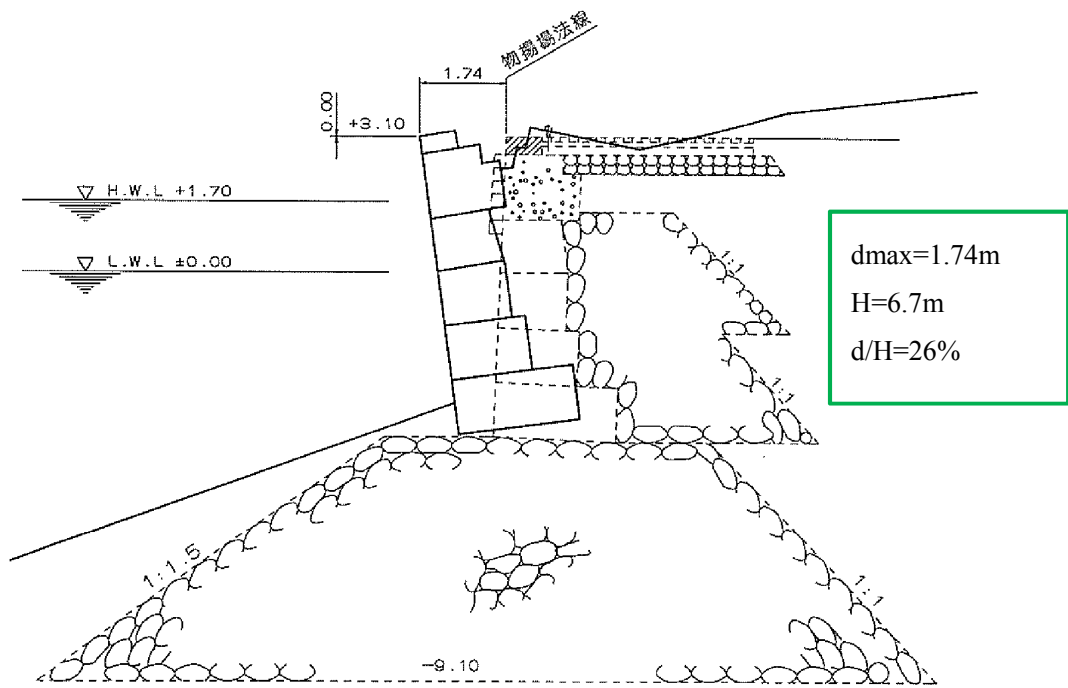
標準断面図，被災状況断面図（A-A）（新港東，④5～6突堤間物揚場）
